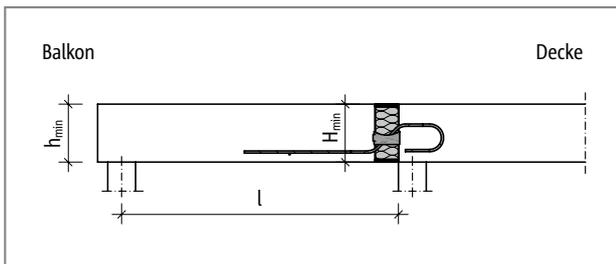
Schöck Isokorb® T Typ QP-V1 und QP-V3: Statisches System
